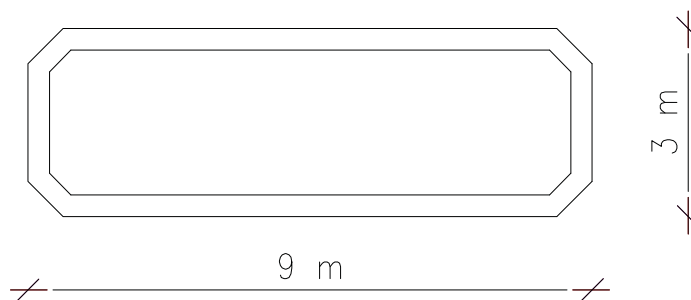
Desenho e respetivas dimensões do pilar em planta da ponte.
